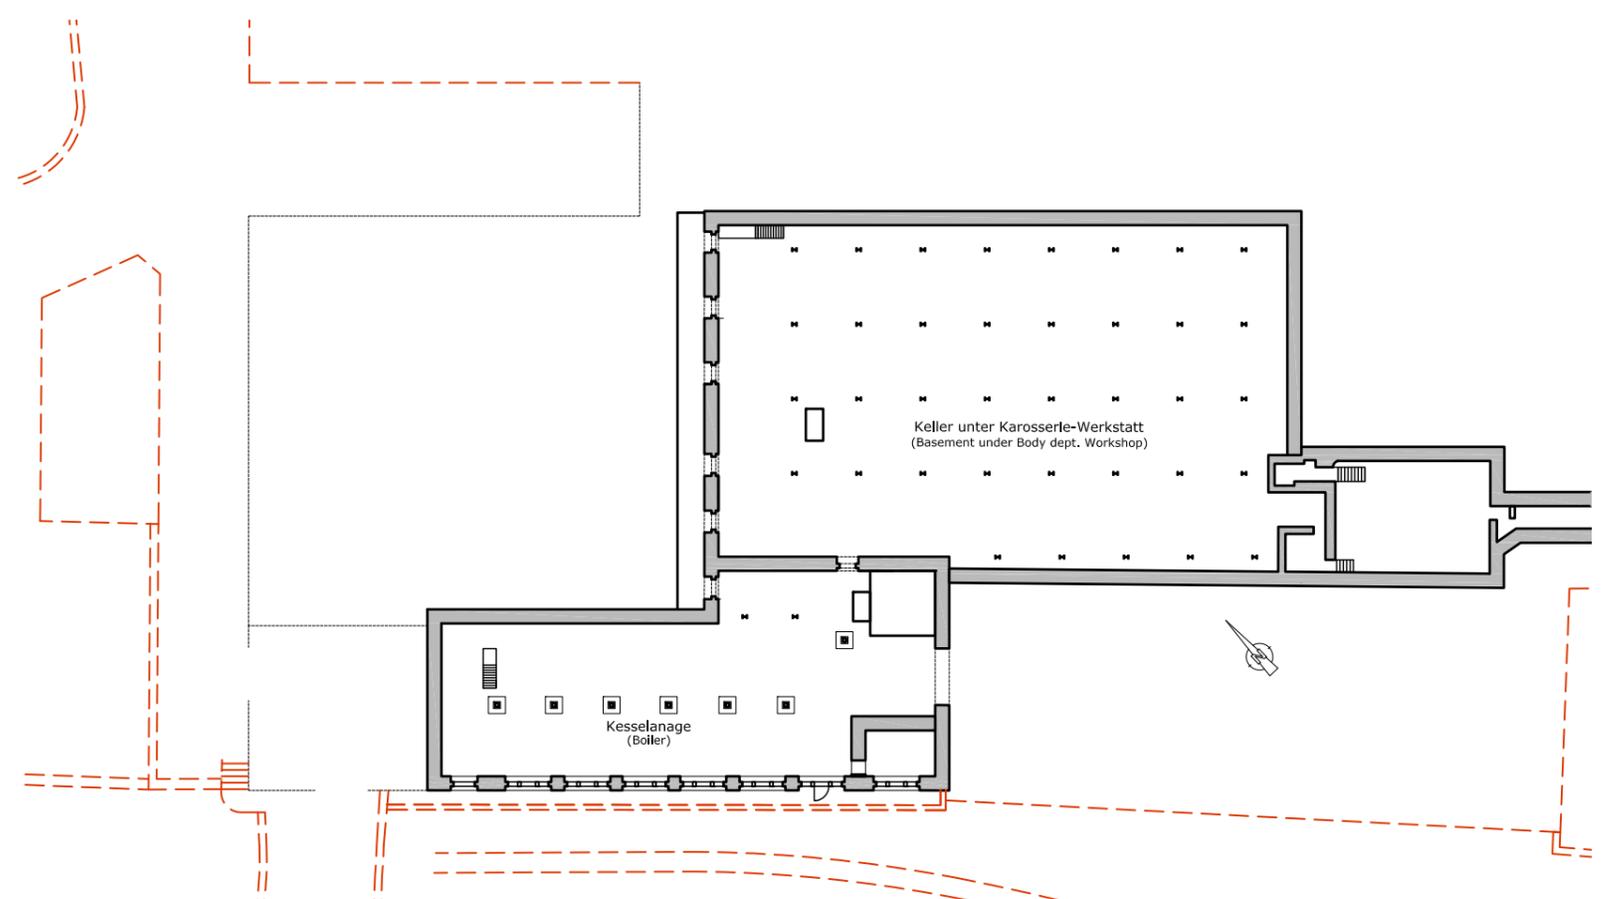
Grundriss Untergeschoss, 1958
